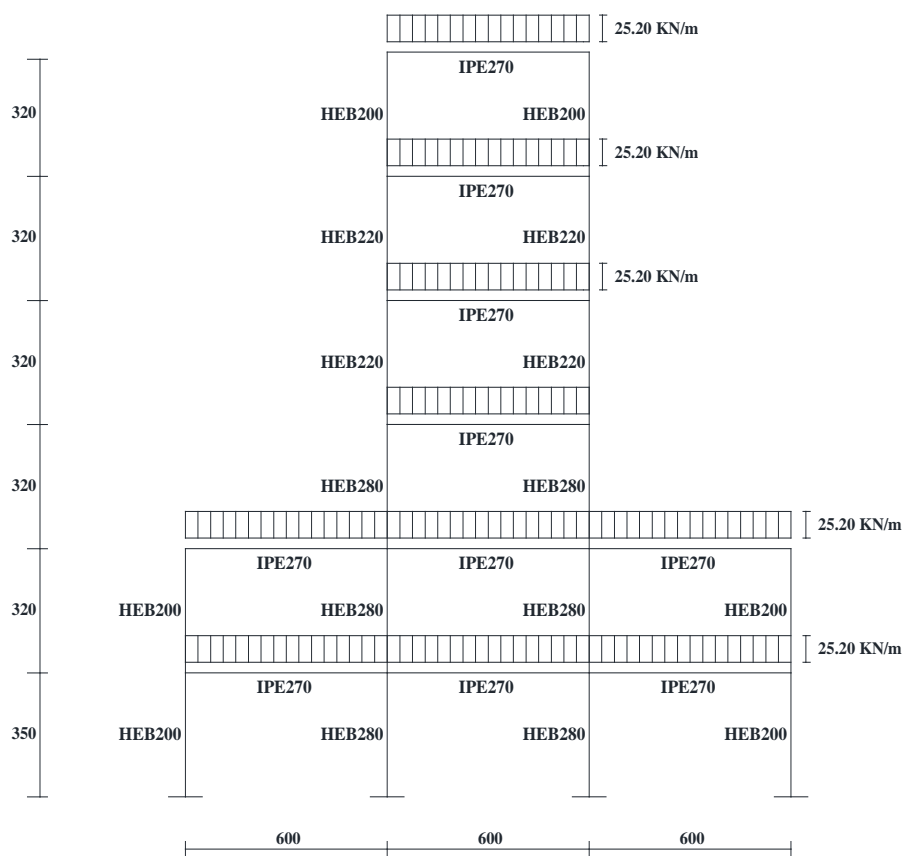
Schema strutturale e profili del Telaio Regolare
